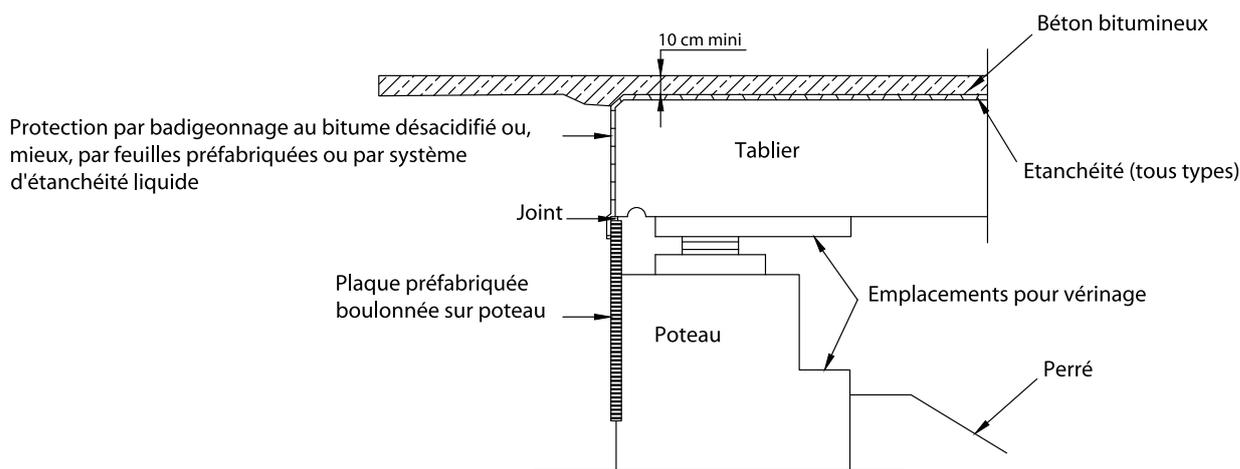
Aménagement dans le cas d'un ouvrage sans retombée de dalle et poteau
